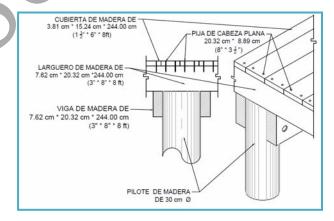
Detalle de la cubierta de madera de los rompeolas y estructura de conexión.
